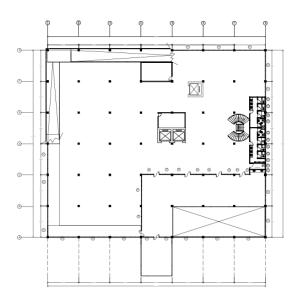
Denah Rencana Plafon Lantai 3 Sumber: dokumen pribadi
